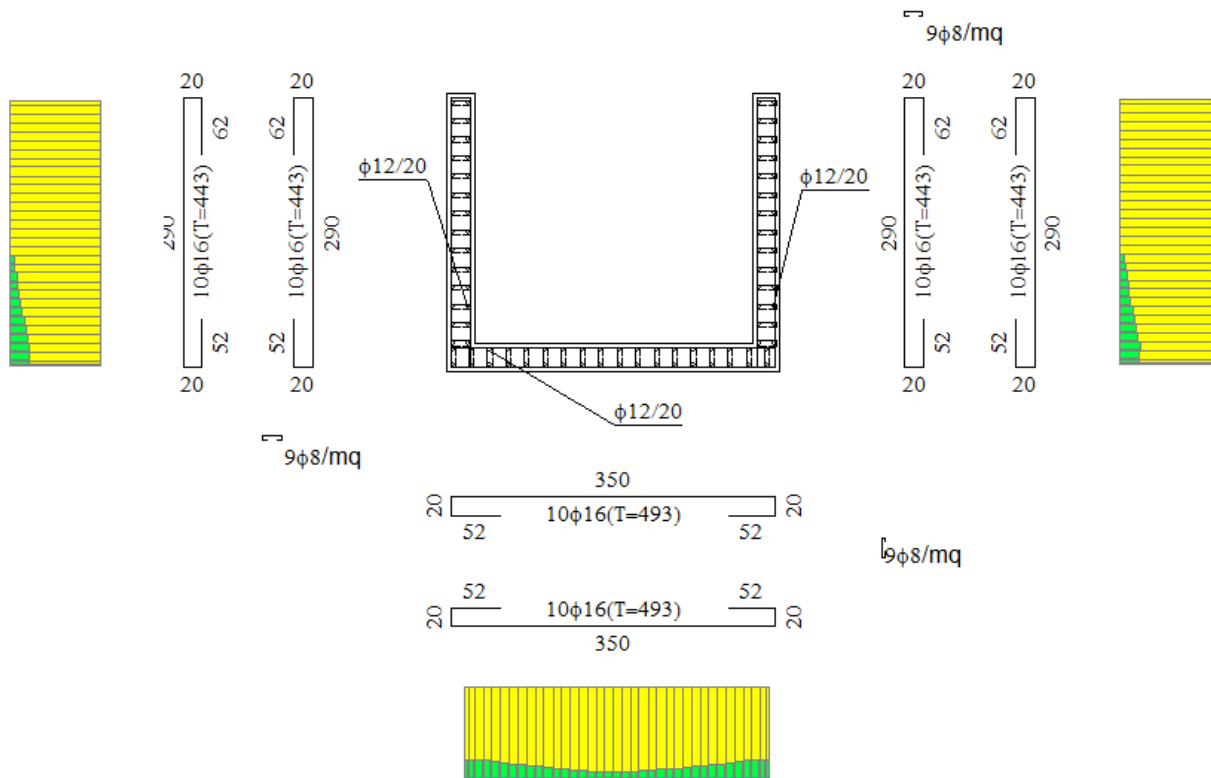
Armature della sezione di calcolo 2 del muro ad U
